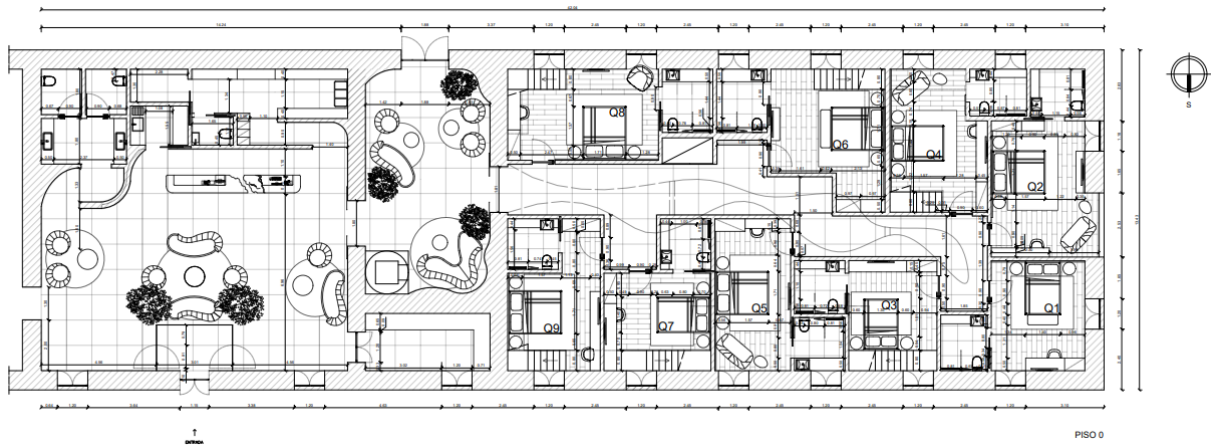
Planta de Equipamento Cotada, Piso 0, Alojamento Olive
